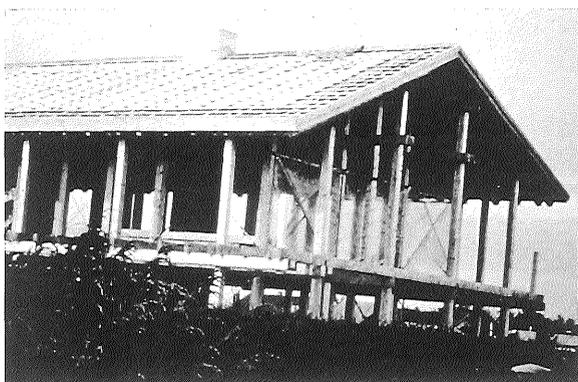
Detalle de entramado de techo prefabricado preparado para su colocación. (Foto Acuerdo de Cartagena).
